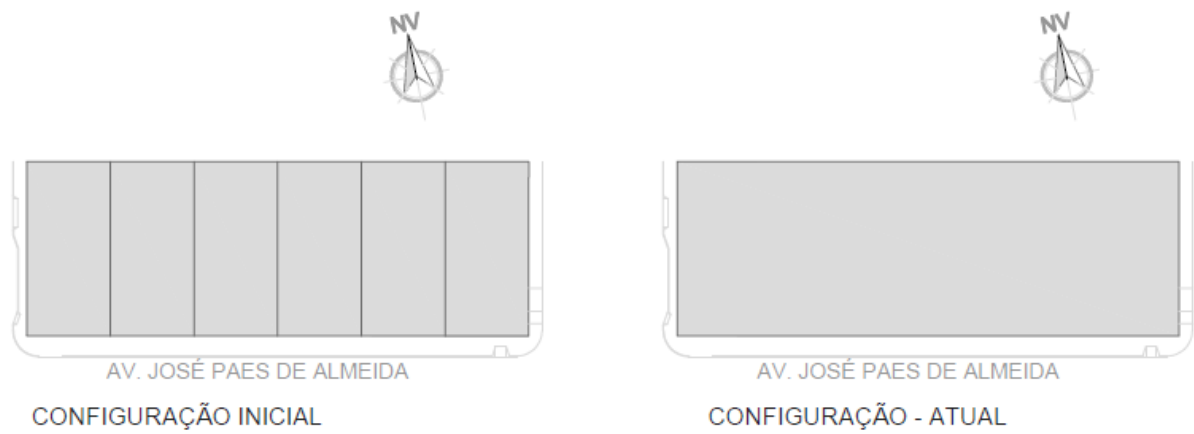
Evolução da configuração dos lotes: situação original do loteamento à época de sua aprovação e configuração resultante da unificação dos lotes para implantação do empreendimento. Fonte: Dos autores.
